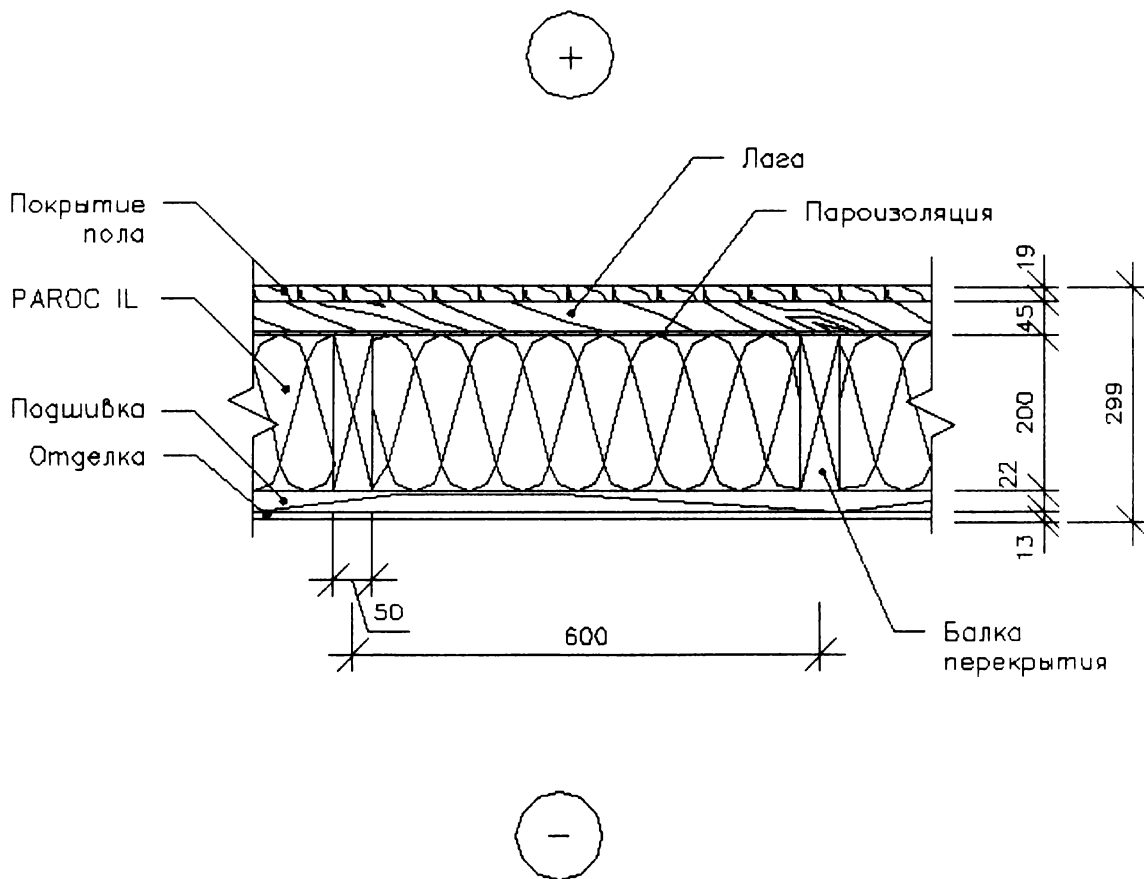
Деревянное перекрытие над вентилируемым подпольем
